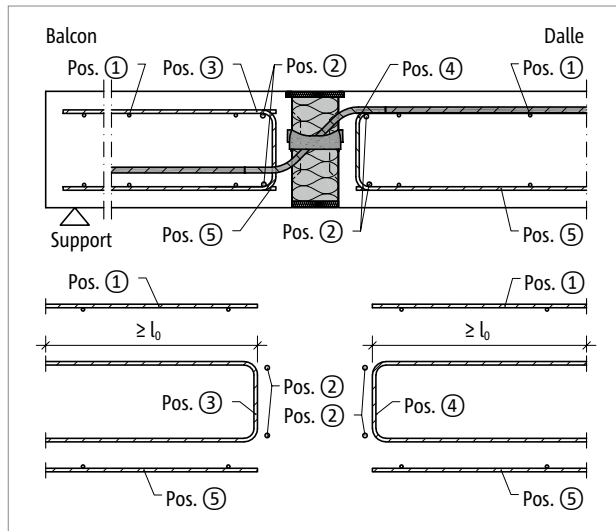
Schöck Isokorb® T Type Q-E-V : Renforcement sur site
